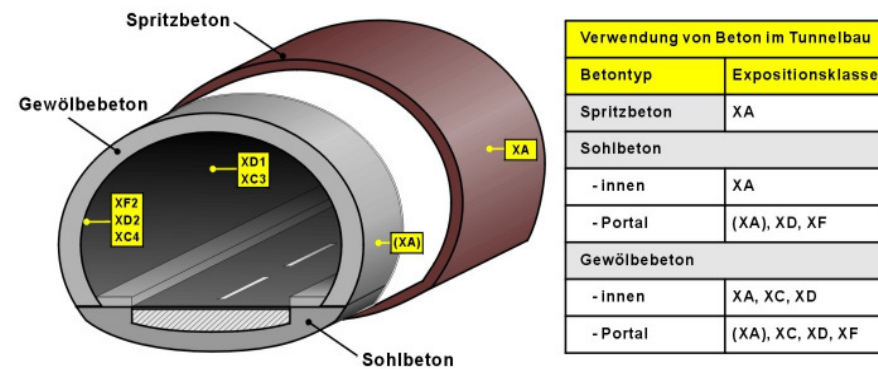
Schematische Darstellung eines Tunnelaufbaus mit den relevanten Expositionsklassen
